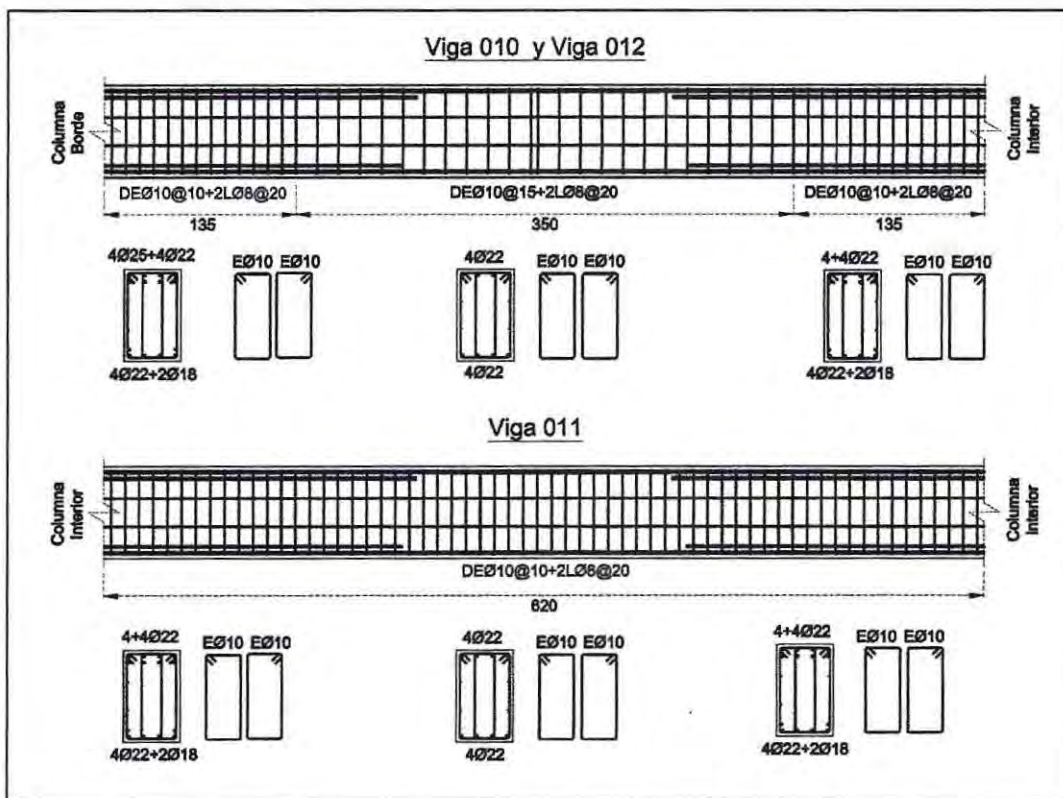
Distribución armadura de corte en vigas Eje B, estructura con marcos.
